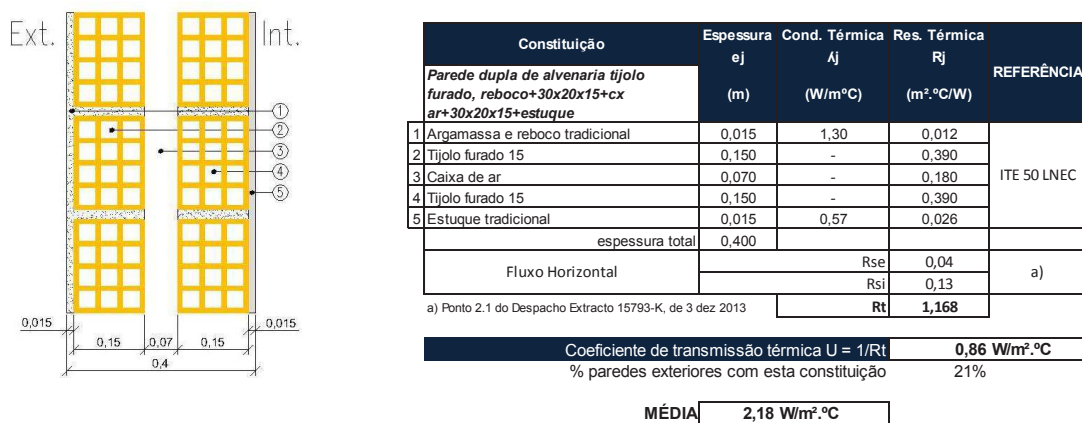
Constituição das paredes exteriores do Centro de Saúde de Penamacor, alvenarias de tijolo furado, com 40cm de espessura.
